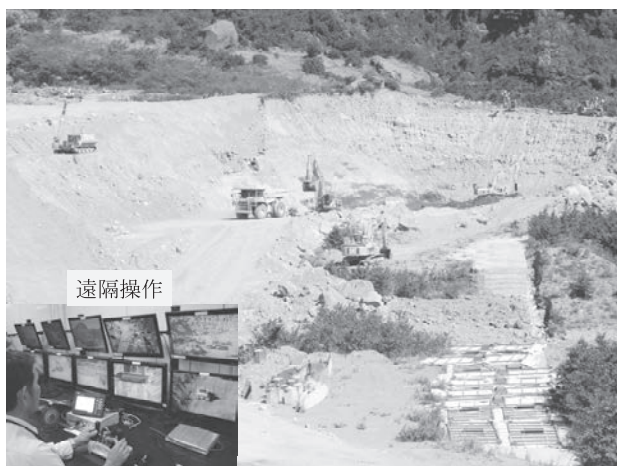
無人化施工による施工状況（2013.9 雲仙復興現場より）
